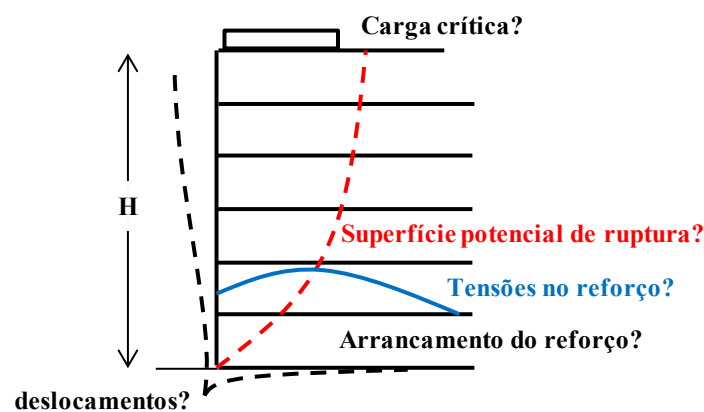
Problemas básicos em mecânica de estruturas de solo reforçado (modificado – Sawicki, 2000).
